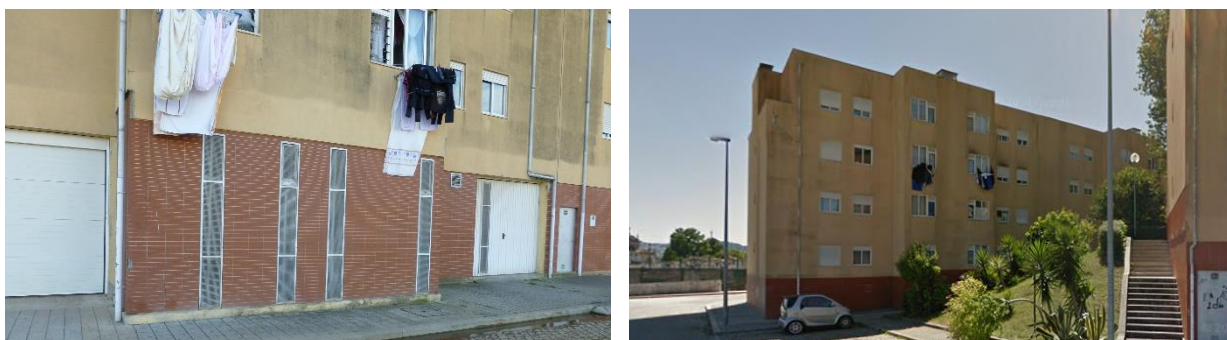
Garagens do bloco B6 e vista da fachada do bloco C
